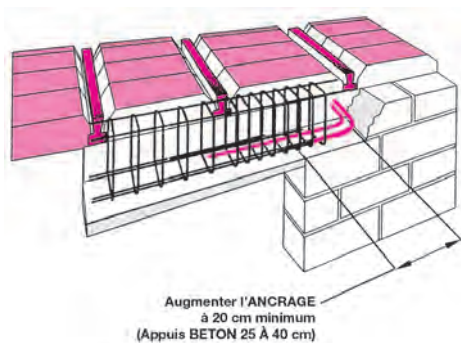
Appui d'une poutre-linteau sur un appui maçonné
